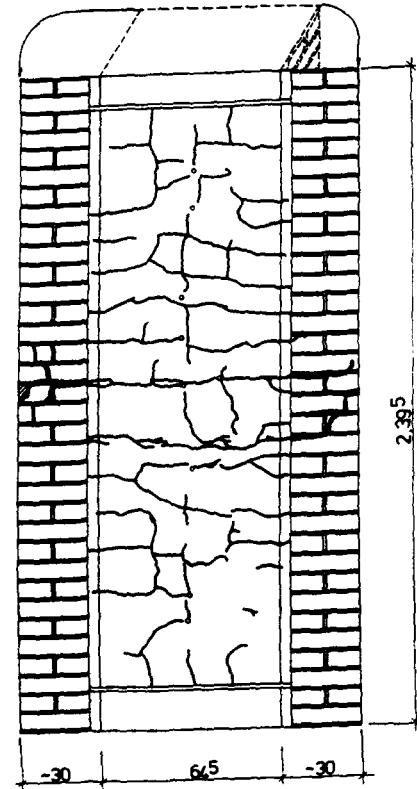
Rißbilder der Stirnseiten einachsrig lastabtragender, unverstärkter Mauerwerkswände
